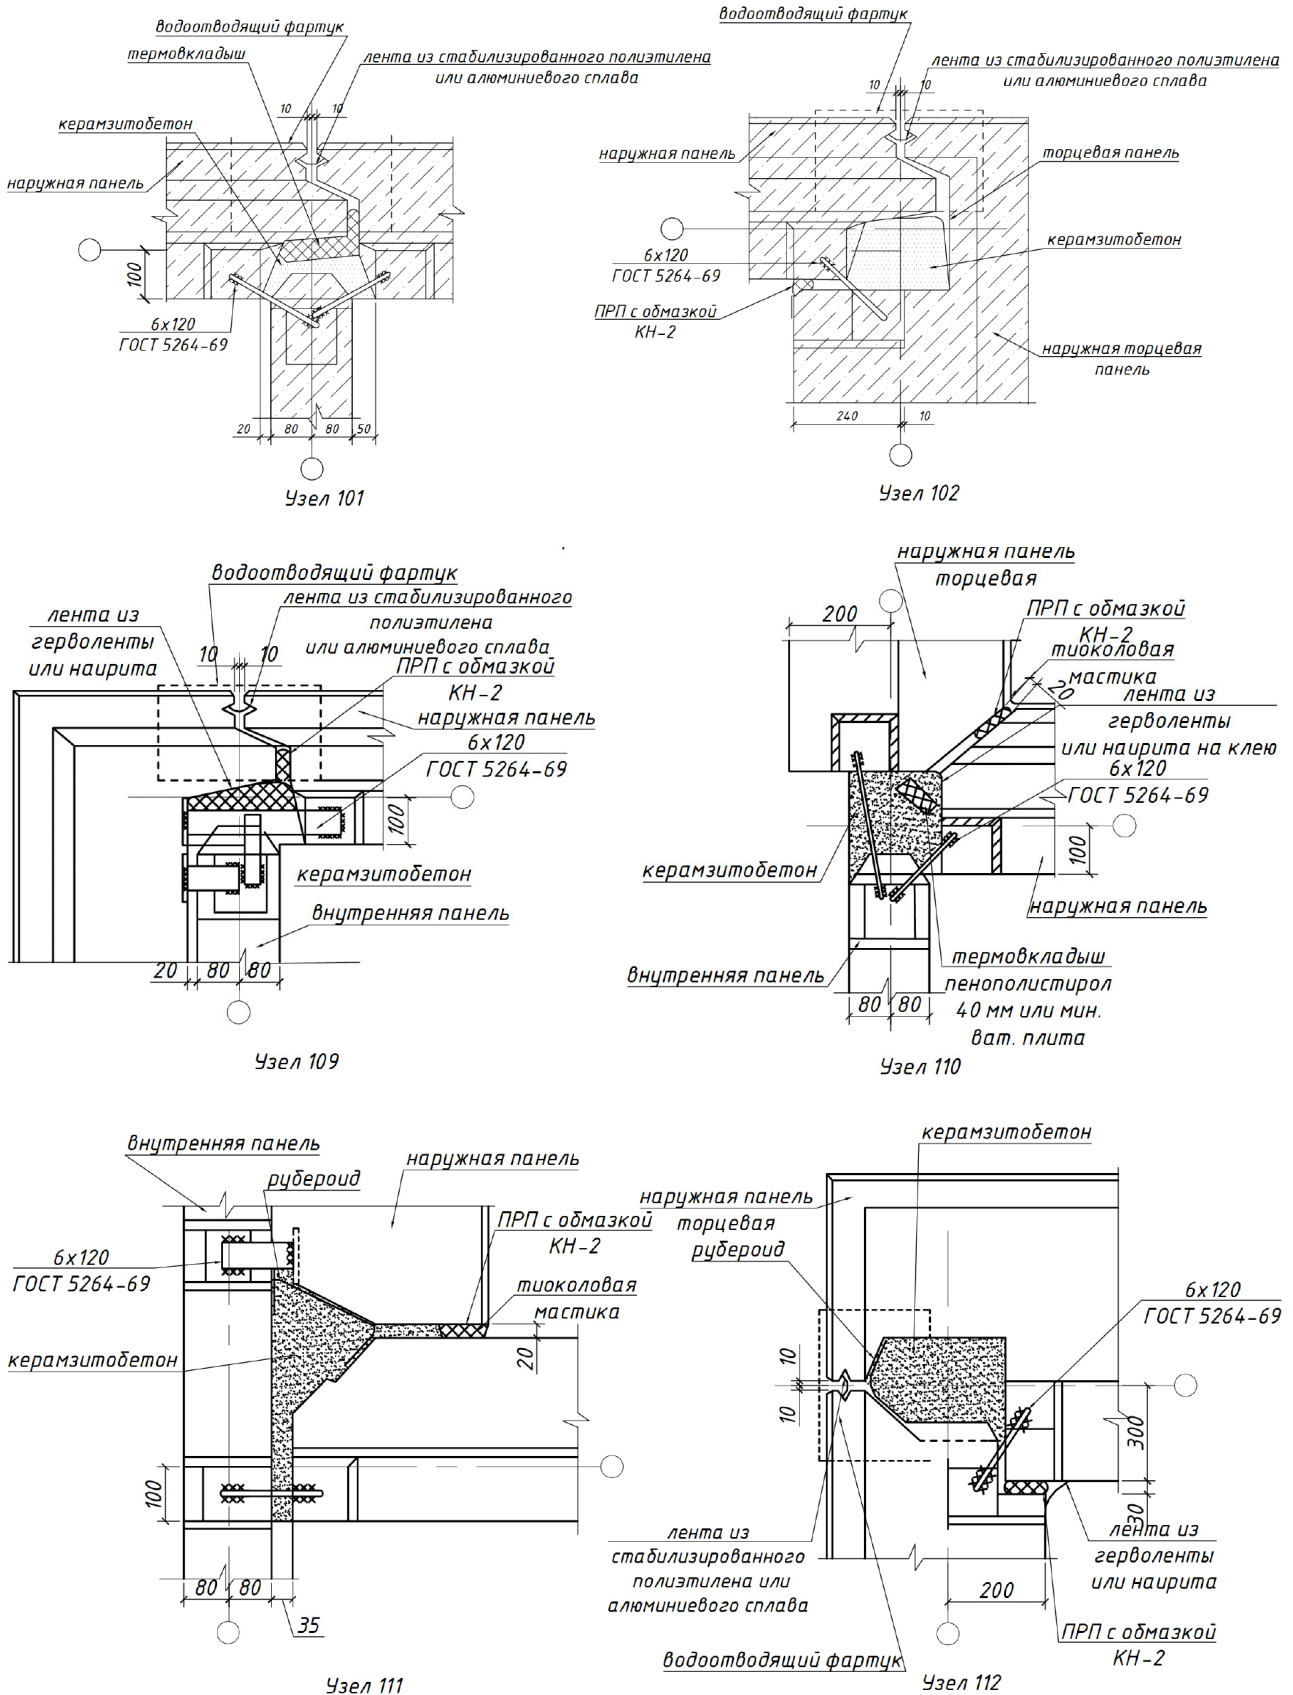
, начало. Узлы сопряжений наружных стен (101; 102; 109; 110; 111; 112; 113; 114)
